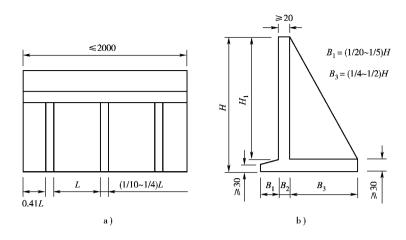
扶壁式挡土墙构造(尺寸单位 km) a)平面图 b)横断面图
